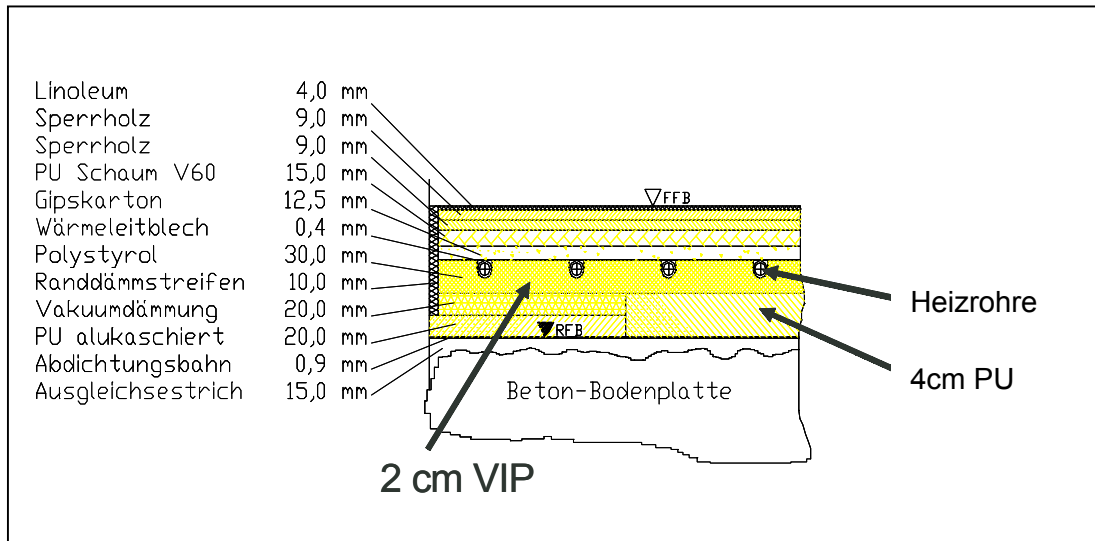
Fußbodenaufbau - Sanierung Turnhalle Gemünden am Main
